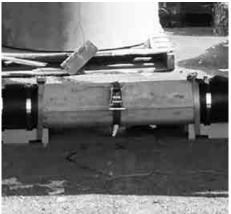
φ150 施工性-滞留水 (規定水深 60mm)
